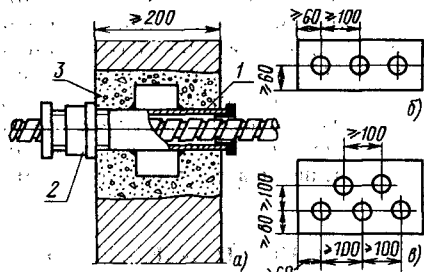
Проходы кабеля с сальниковым уплотнением из взрывоопасных зон одного класса во взрывоопасные зоны другого класса; в помещении с нормальной средой или наружу:
